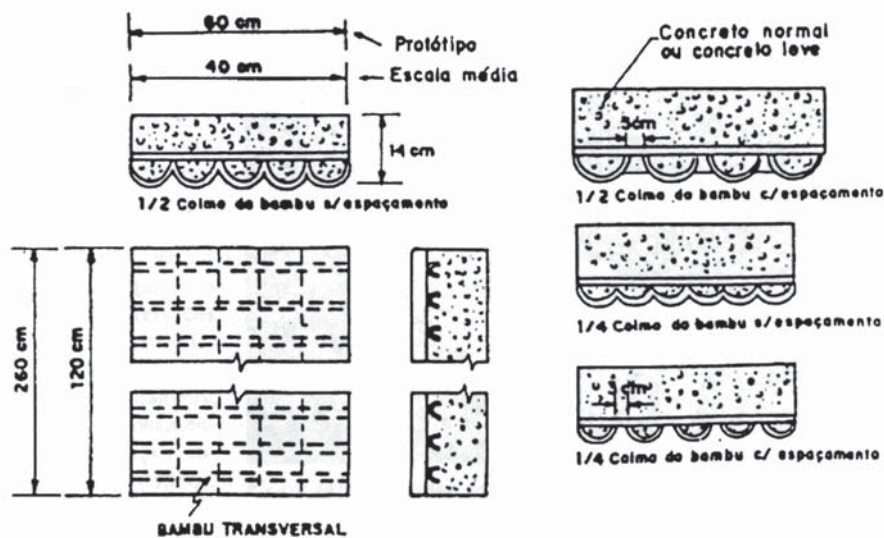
Laje armada com forma permanente de bambu (GHAVAMI).
